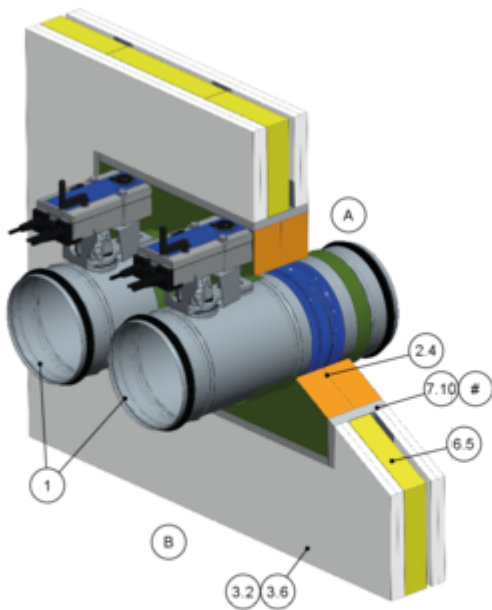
Trockeneinbau mit Weichschott in Leichtbauwand
